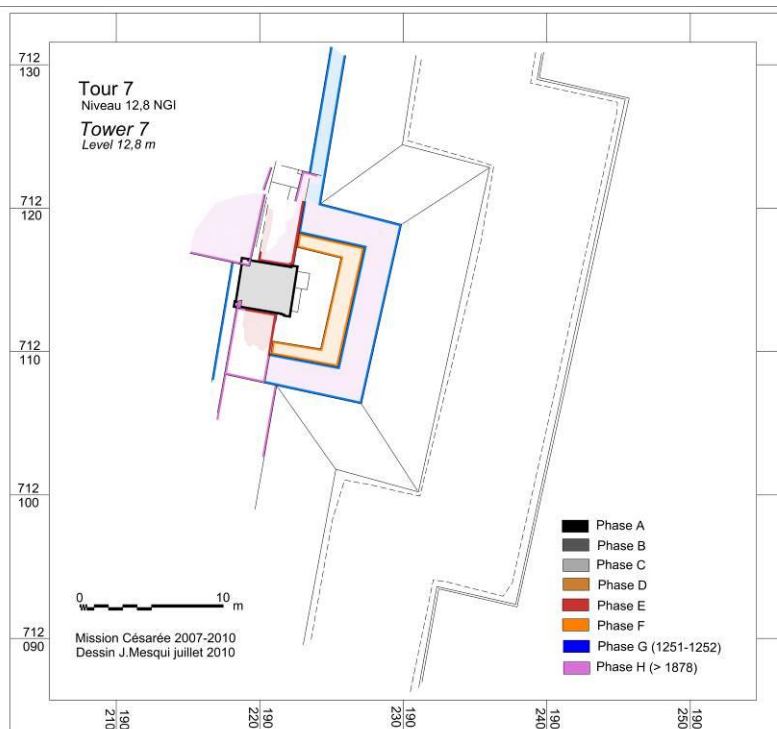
Plan de la tour T7 au niveau 12,8 m ASL
